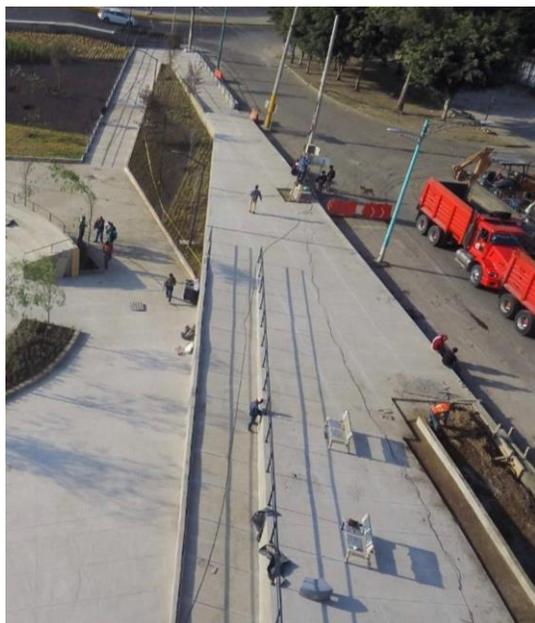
Vista aérea de la construcción de barandales en rampas de acceso universal. (Archivo Personal)
